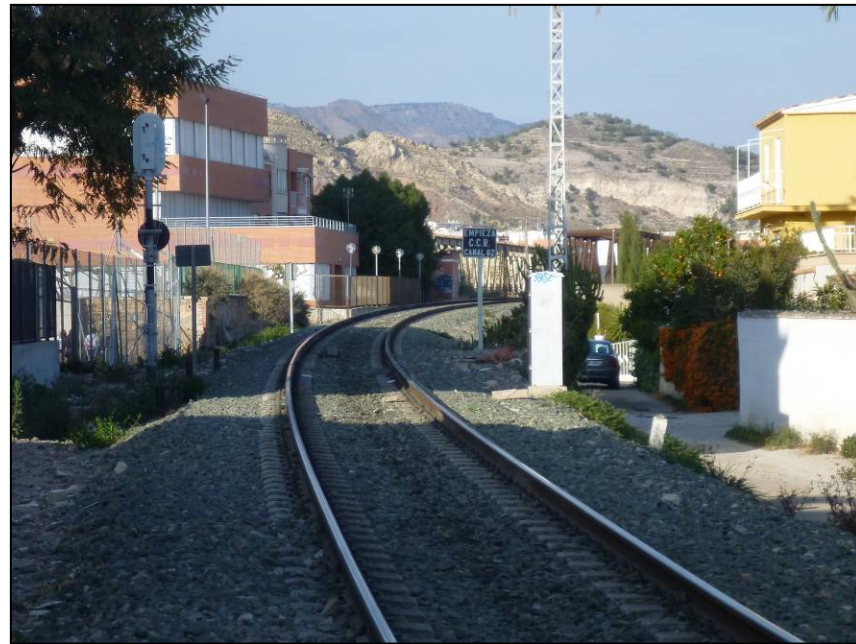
Vista de la línea ferroviaria hacia Santa Clara desde el P.K. 49+670 (202+520).
